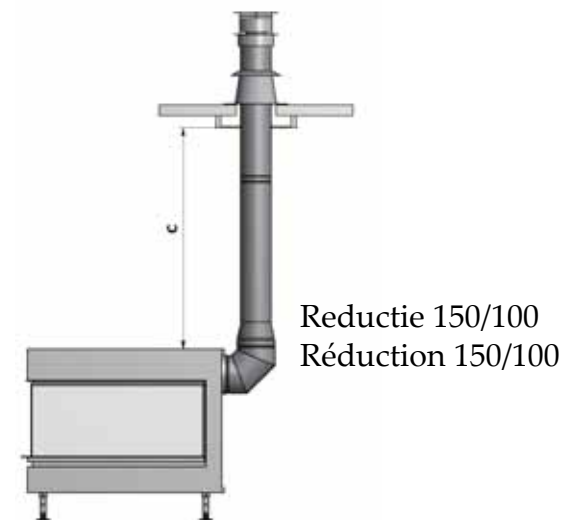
DAKDOORVOER VIA BESTAANDE SCHOUW / RACCORDEMENT TOIT VIA CHEMINEE EXISTANTE (C91)
